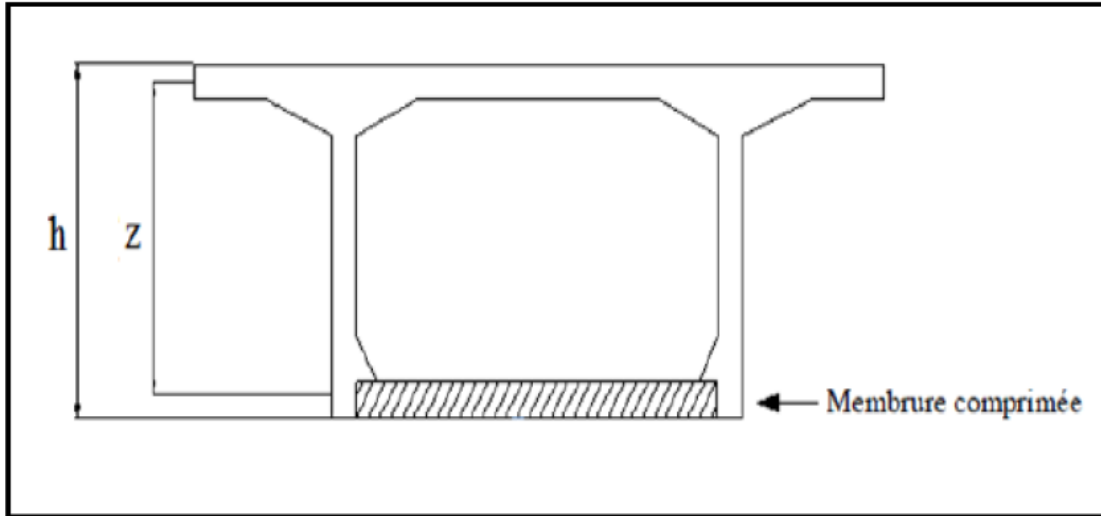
Prise en compte de l'effet RESAL sur les poutres caisson.
